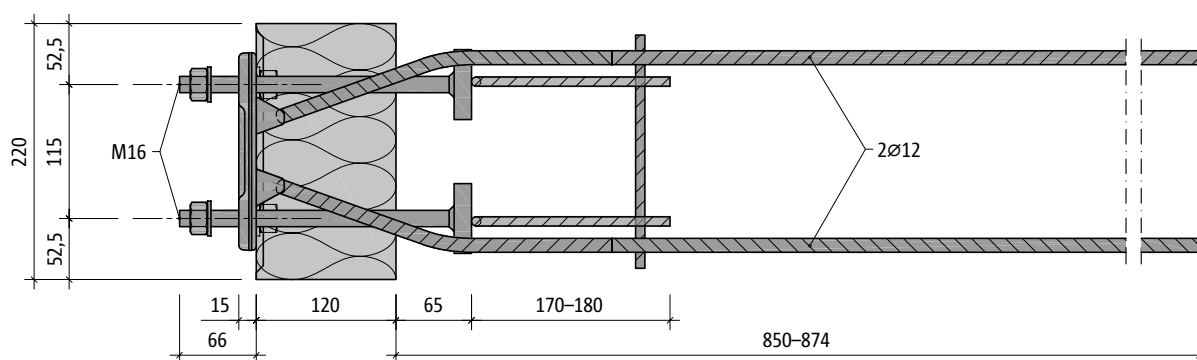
Schöck Isokorb® XT type SQ-V3 : vue en plan
